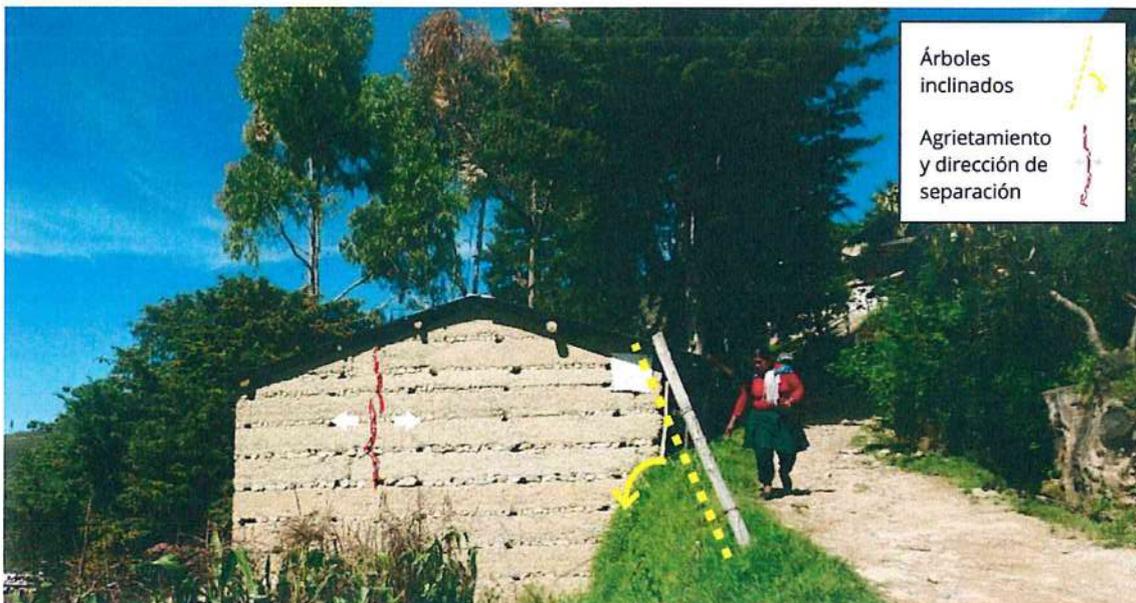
Poste inclinado y vivienda agrietada en ladera de zona habitada del cerro El Calvario, colindante camino de acceso. La vivienda se encontraría construida sobre relleno.
